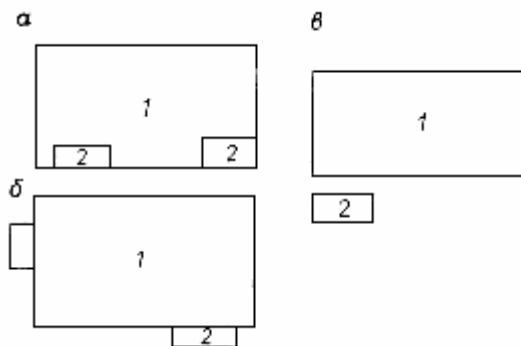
Помещения РУ, ТП и ПП для взрывоопасных зон:
